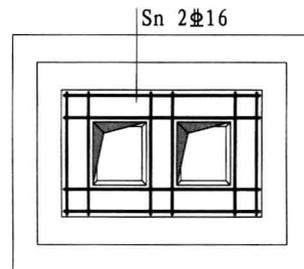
双杯口独立基础顶部焊接钢筋网示意
